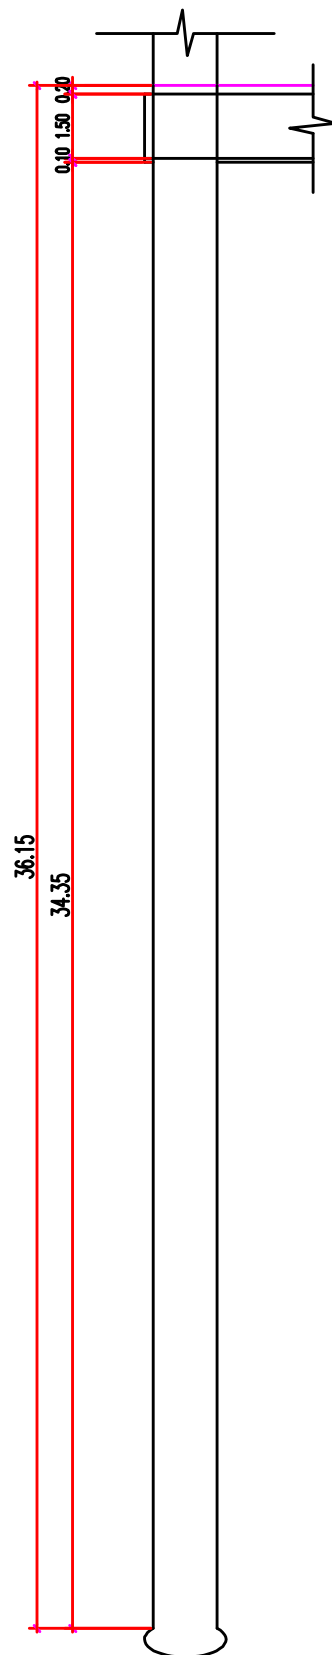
Pilar SVA16: Zona Enterrada no Solo
